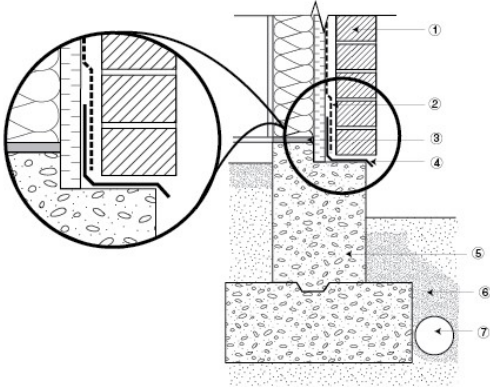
Tyvek® CommercialWrap® – Détail de la base du mur de fondation
